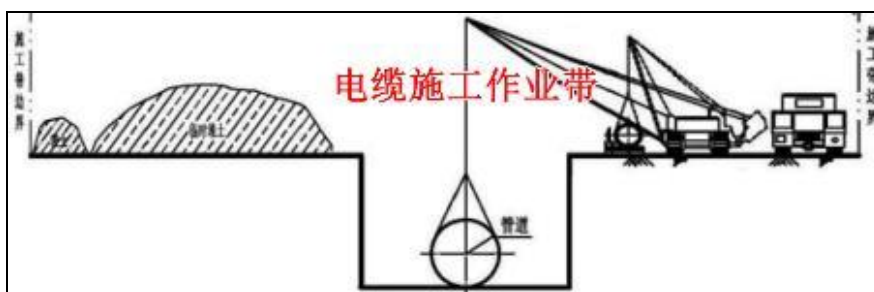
电缆线路沟槽施工作业带施工布置示意图
